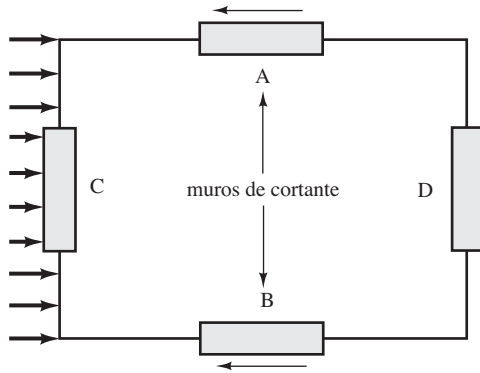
Vista en planta de un piso soportado por muros de cortante.
